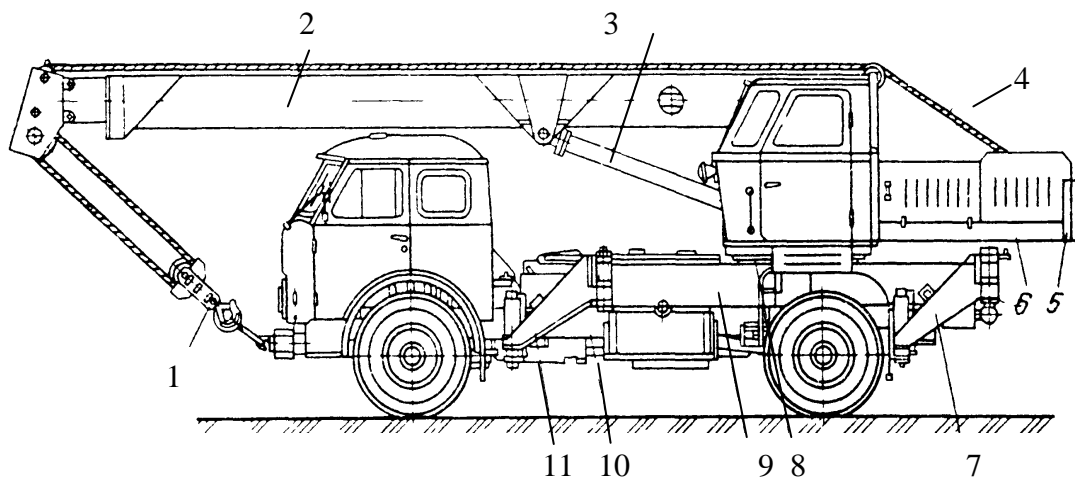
Автомобильный кран с жесткой подвеской рабочего оборудования: 1 – крюковая подвеска; 2 – телескопическая стрела; 3 – цилиндр подъема стрелы; 4 – канат; 5 – противовес; 6 – поворотная рама; 7, 11 – выносные опоры; 8 – опорно-поворотное устройство; 9 – рама; 10 – ходовое устройство (шасси автомобиля)
